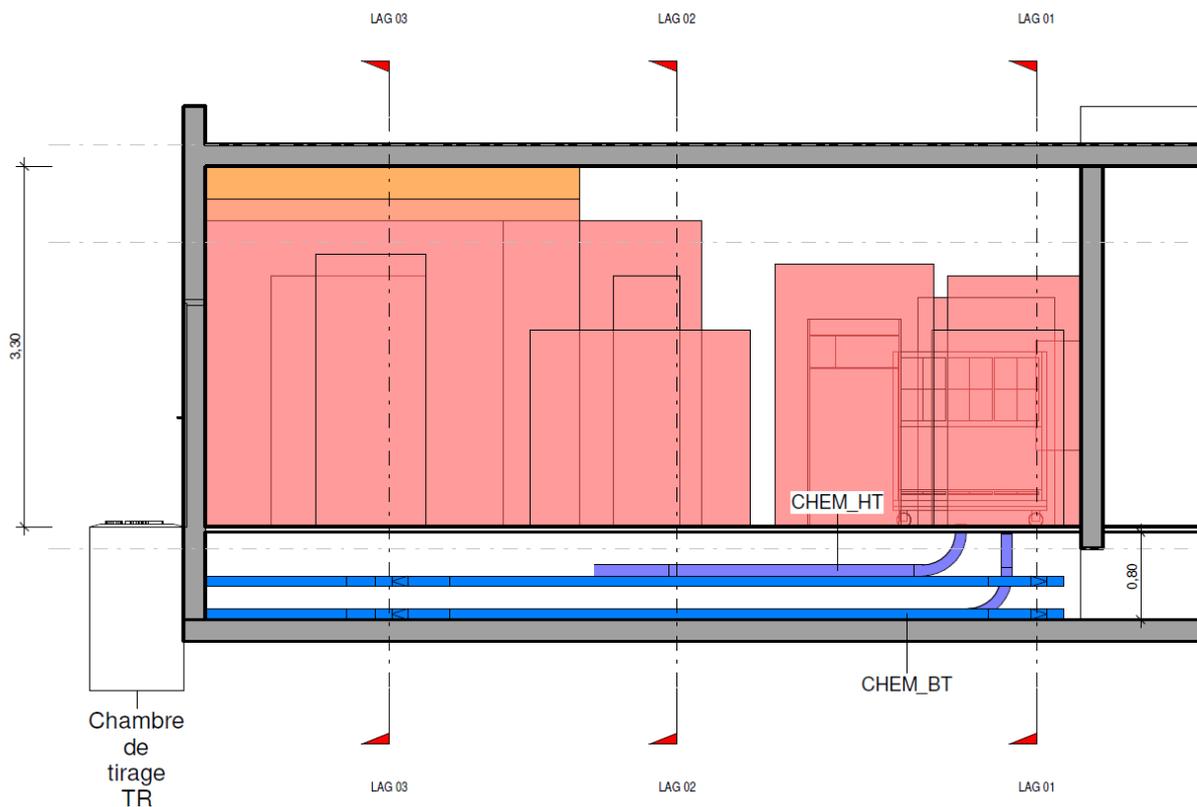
Exemple d'une vue en coupe d'une sous-station
